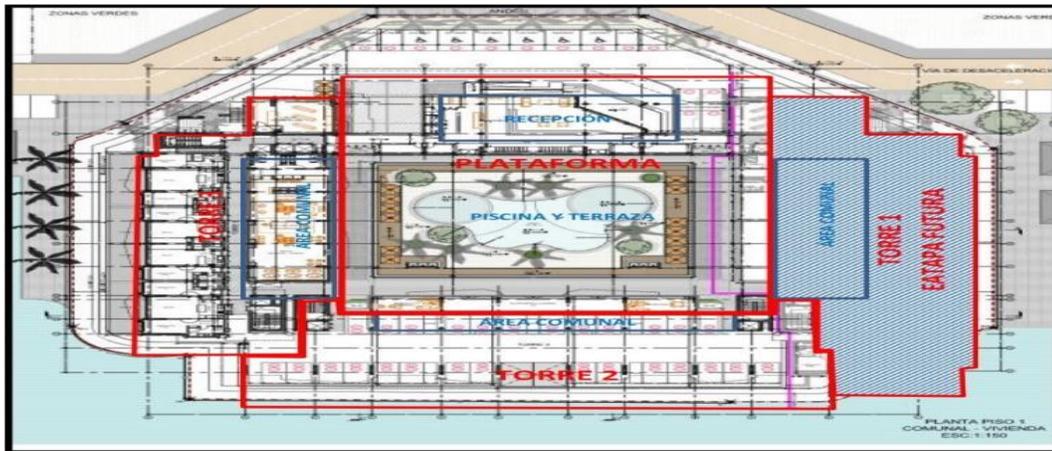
Vista en planta de la proyección urbanística del proyecto, Fuente: solicitante
